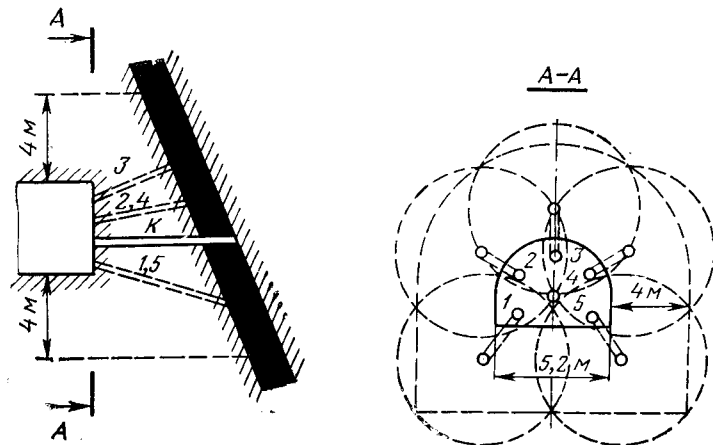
Схема расположения скважин в забое квершлага для гидрообработки угольного пласта перед его вскрытием
